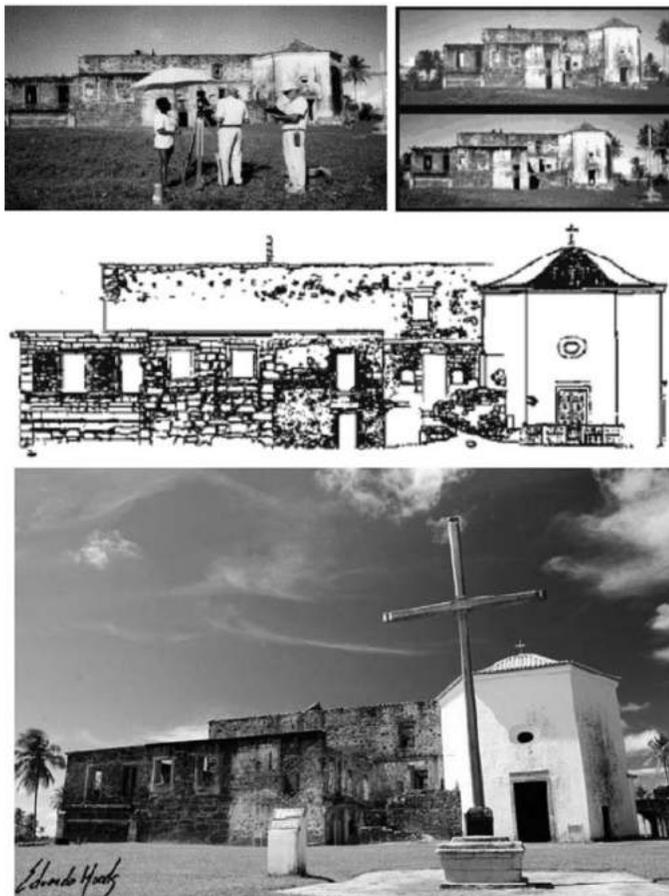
Castelo Garcia d'Ávila – vista do levantamento fotogramétrico terrestre, par estereoscópico, planta da fachada e fotografia artística da construção com a capela semi-restaurada (fonte: Fundação Garcia d'Ávila) (Apud, COELHO E BRITO, 2007 - p. 67).
